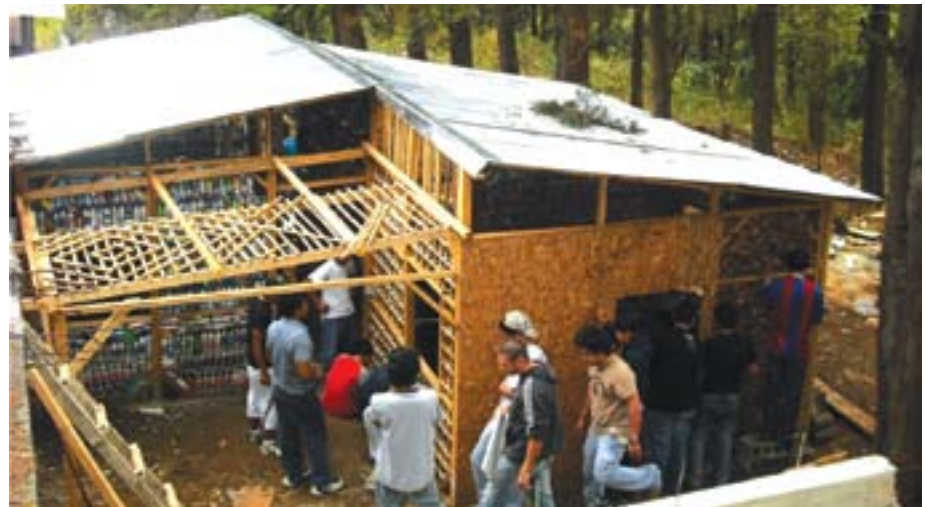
Albergue Versátil en proceso de construcción. Fuente: INDIS.
